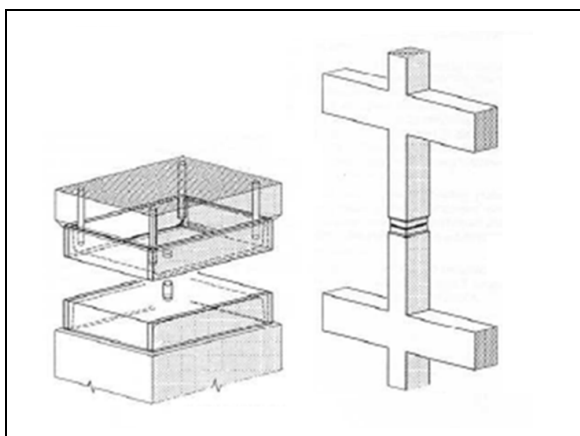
Ligação por soldadura de perfis nas faces (Stupré, 1981)
